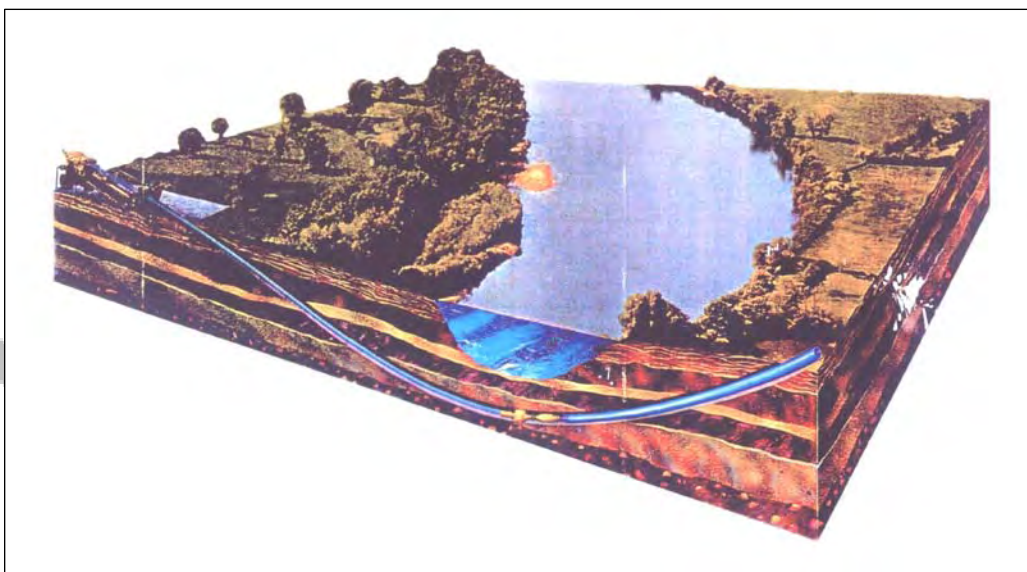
Equipamento utilizado na execução de furos direcionais.
